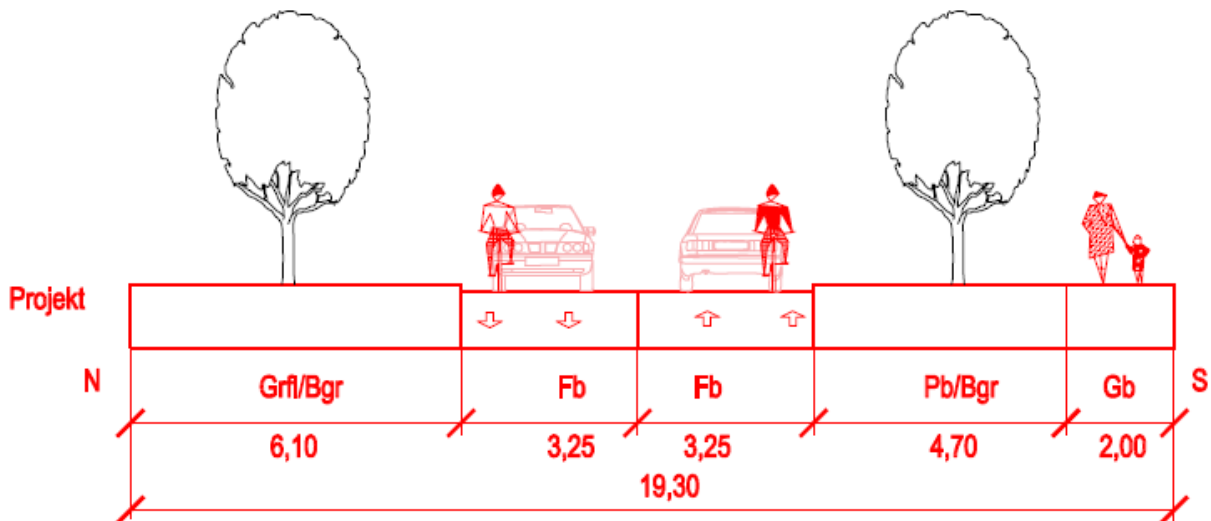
Schematische Darstellung Planung Vorzugsvariante Querschnitt Truderinger Straße zw. Truderinger Str. 148 und Auf dem Wasen; (Quelle: Ing.-Büro Dr. Zimmermann)
